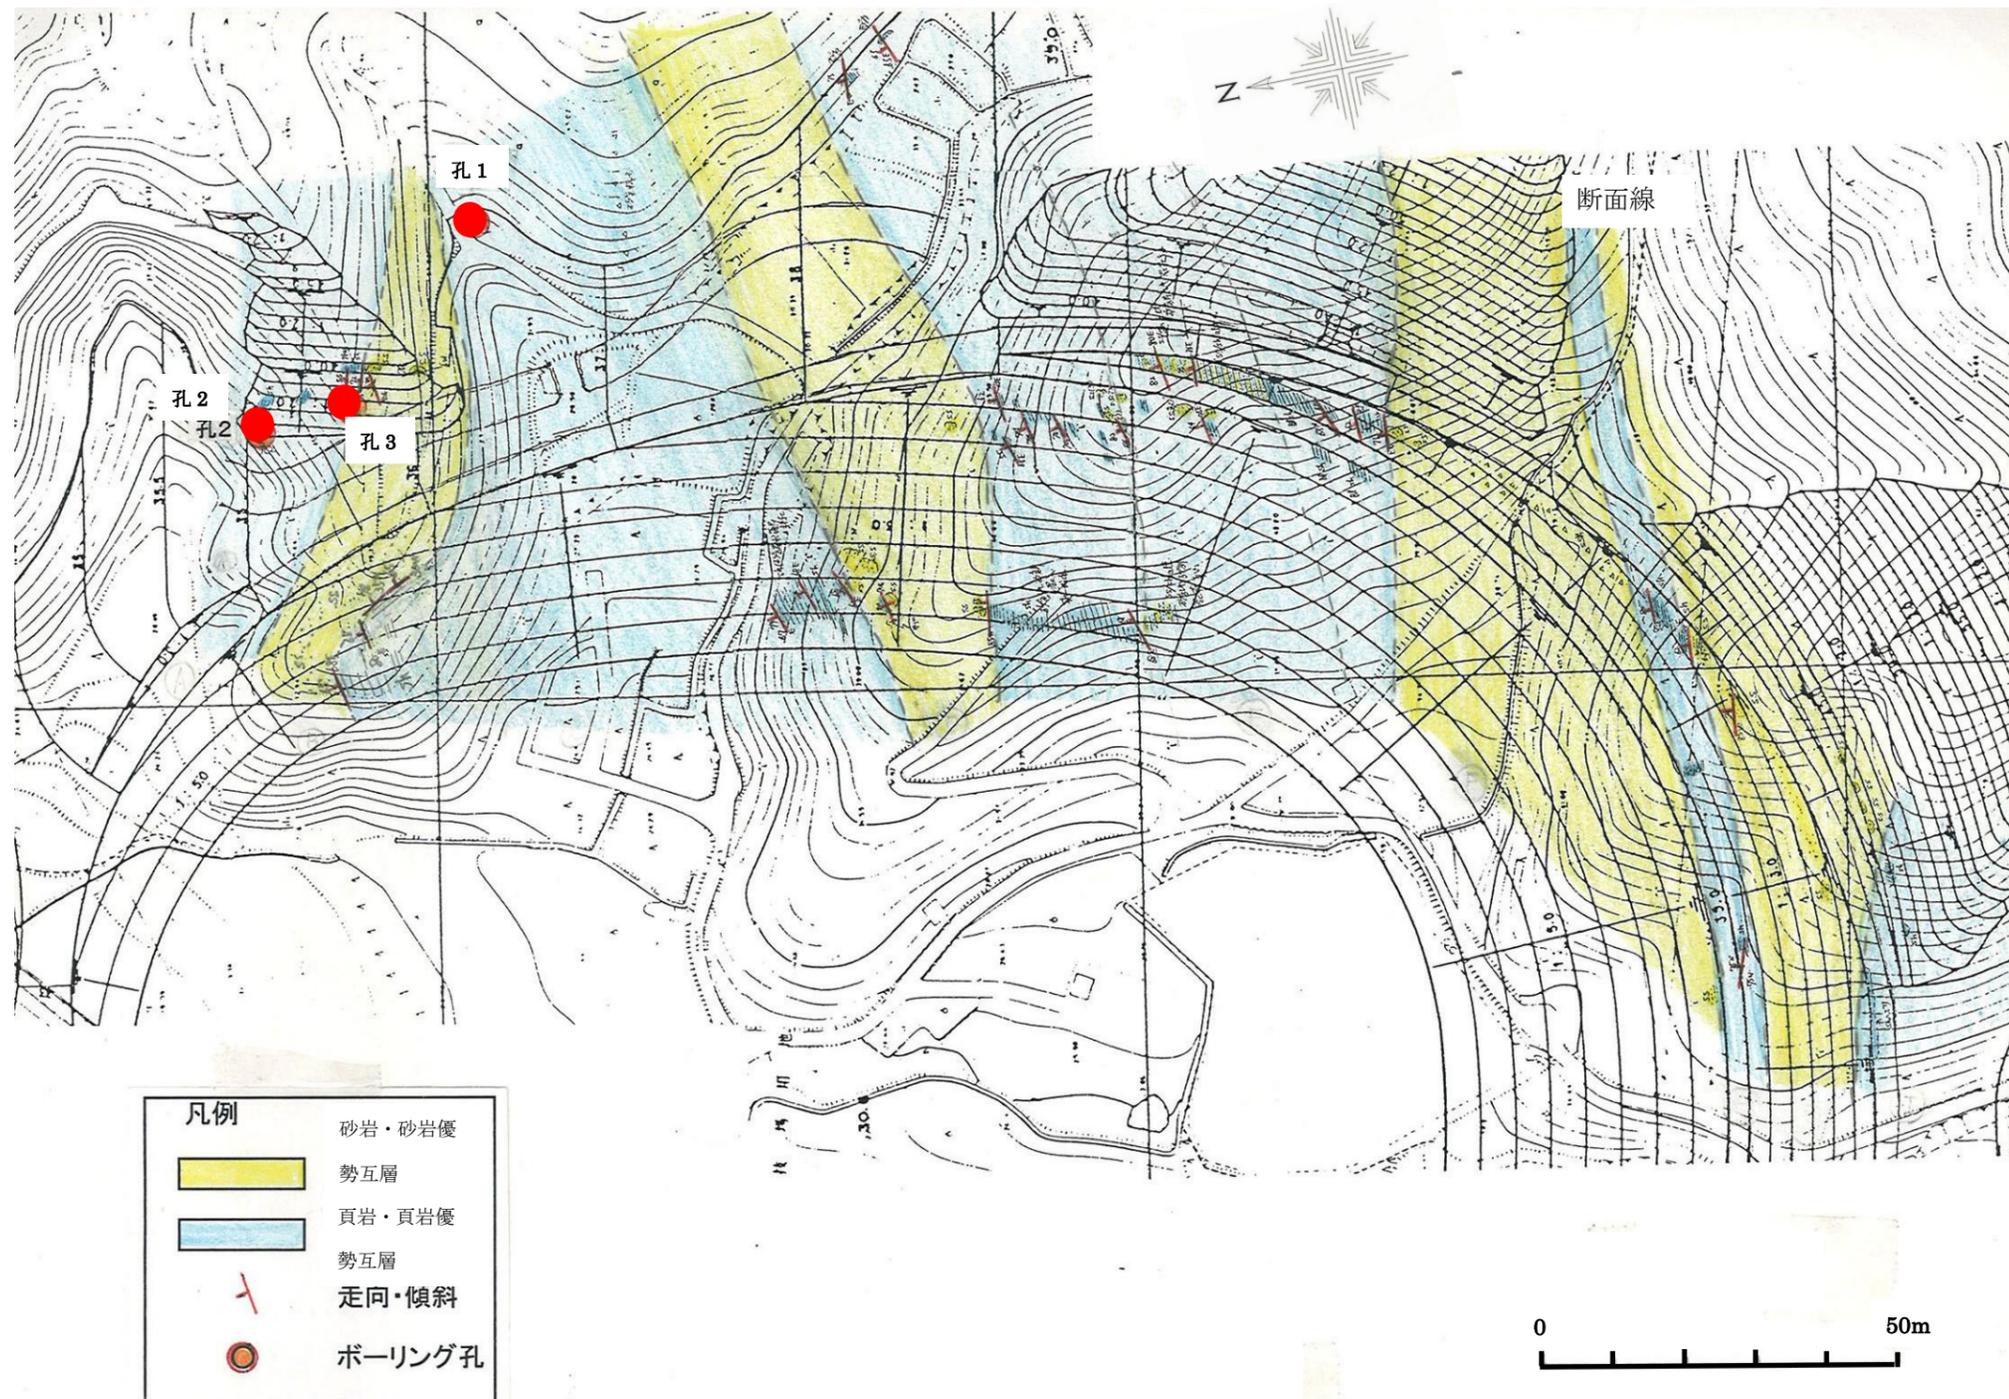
ボーリングサイト近傍の地質平面図（「徳島県土木部 南部健康運動公園 造成計画平面図（5）」を使用）
